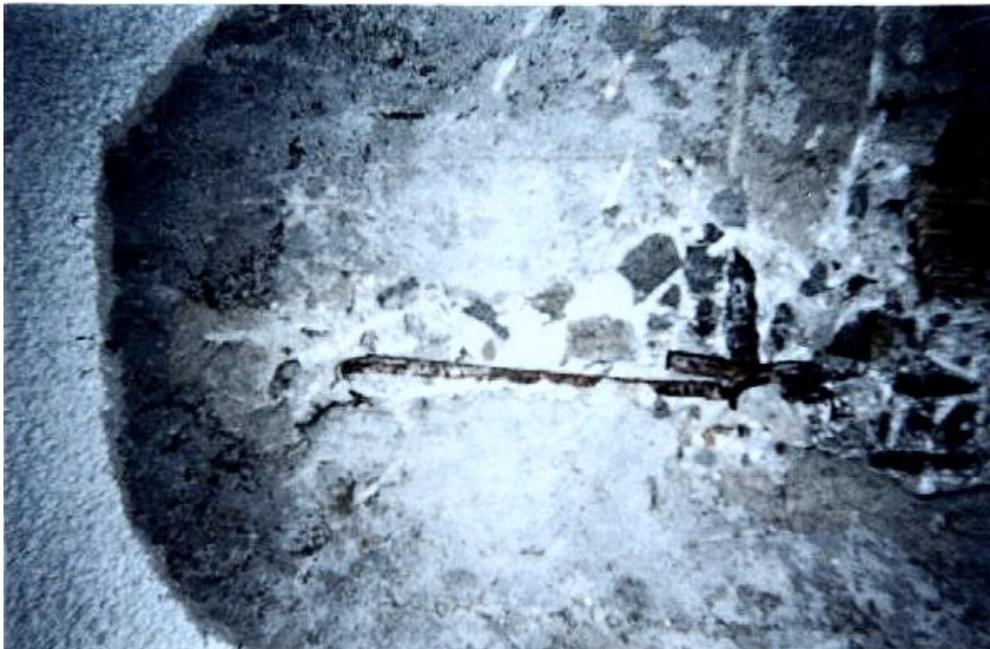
Viga de cimentación y cimiento corrido en concreto ciclópeo
